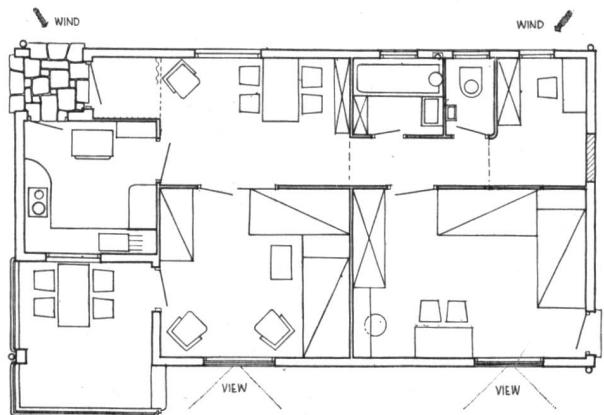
Grundriss eines Zweizimmerhauses; die Wohnzimmer sind der vorherrschenden Windrichtung abgewendet.
